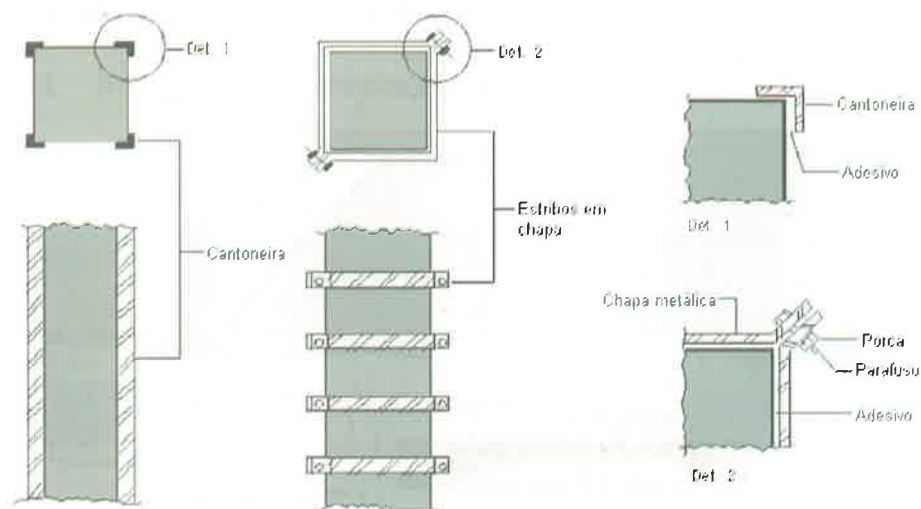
Reforço de pilares com chapas metálicas aderidas com epóxi.
